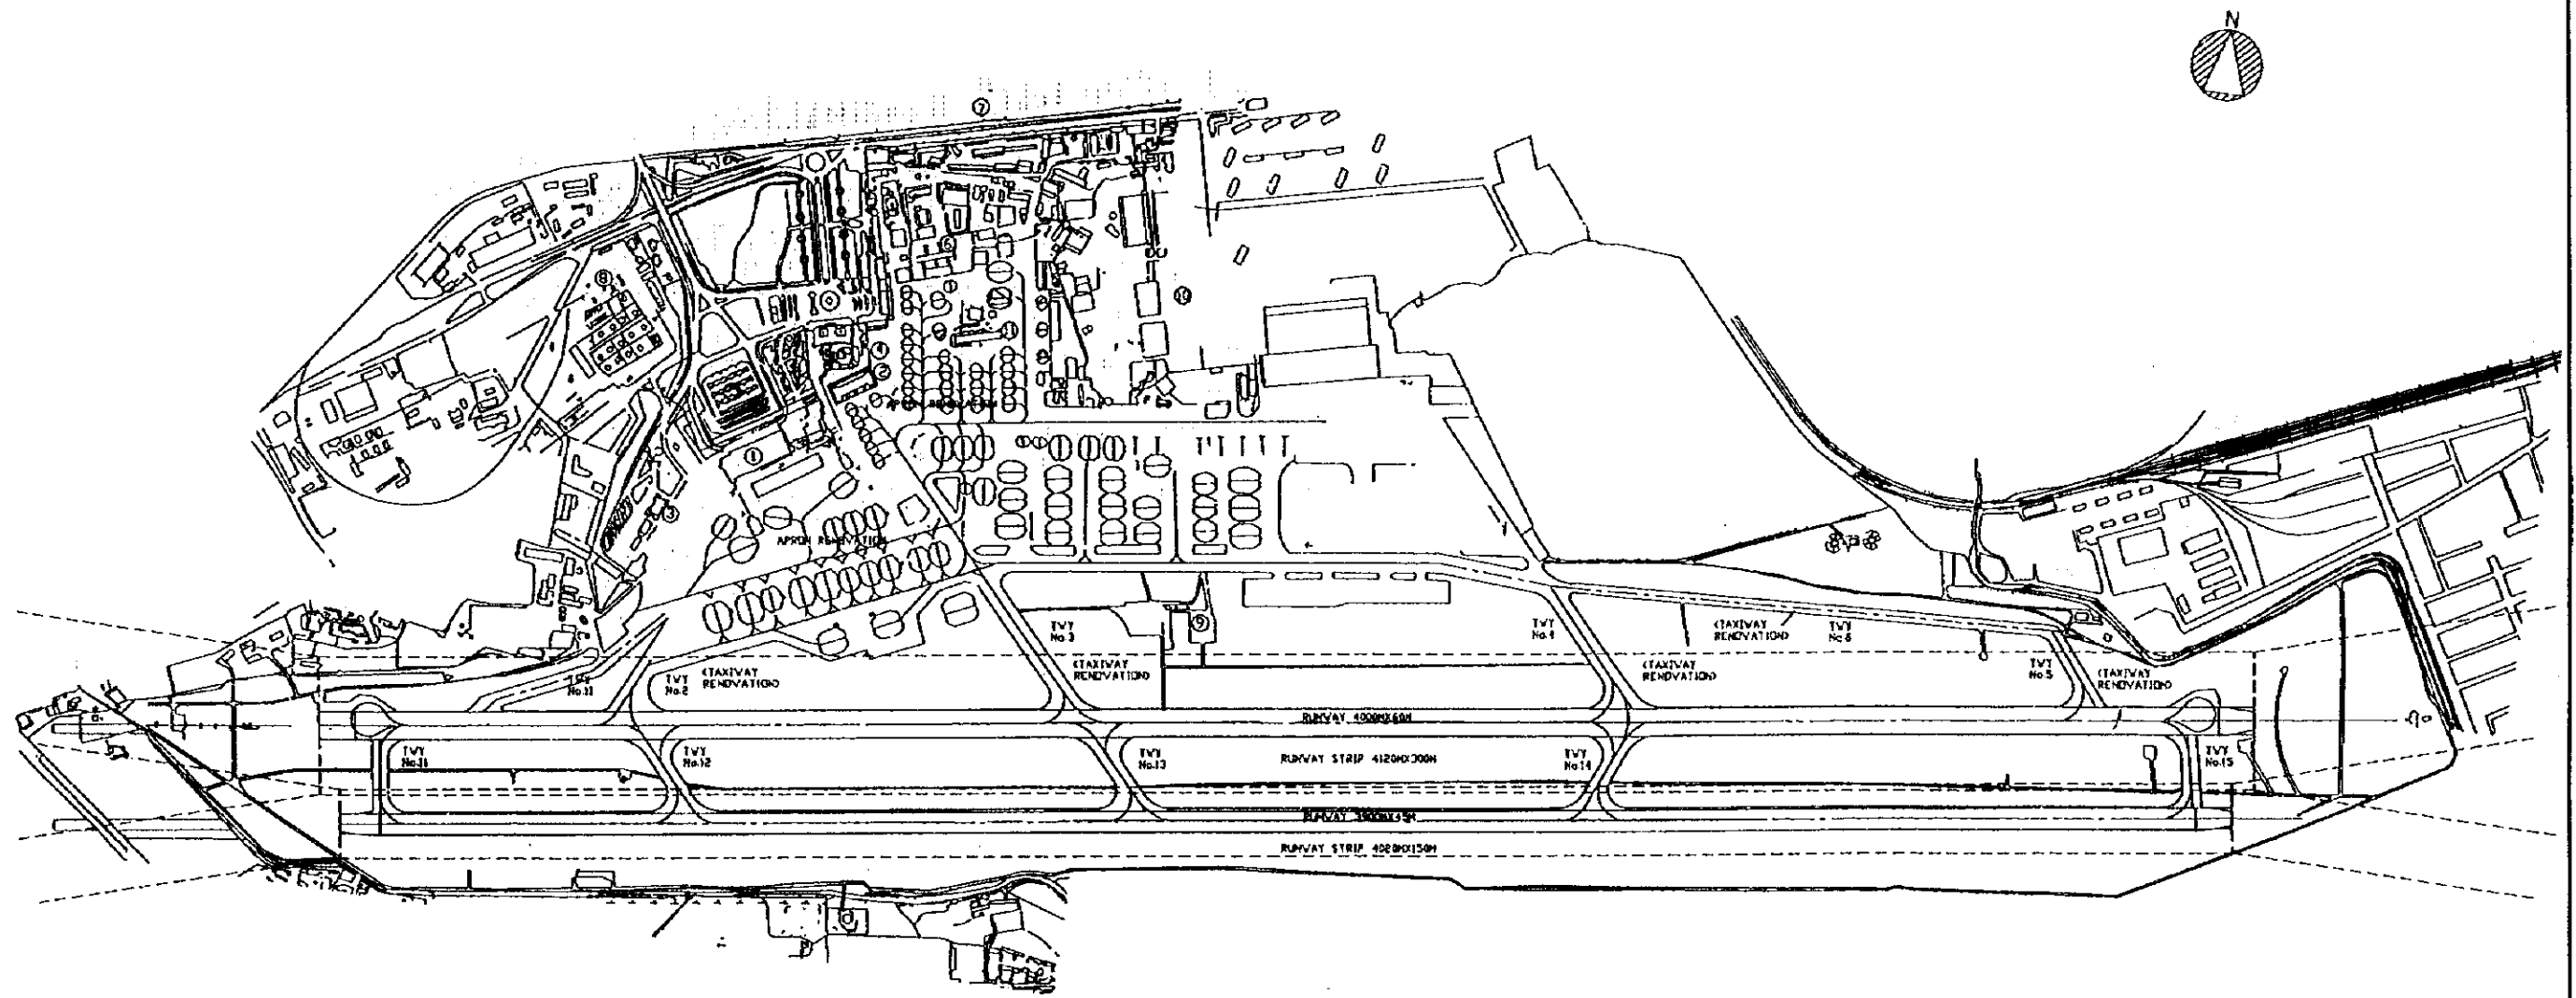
(1) План размещения аэровокзального комплекса
